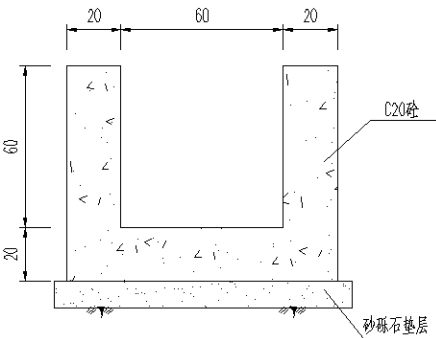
弃渣场截水沟设计断面示意图（单位:cm）
